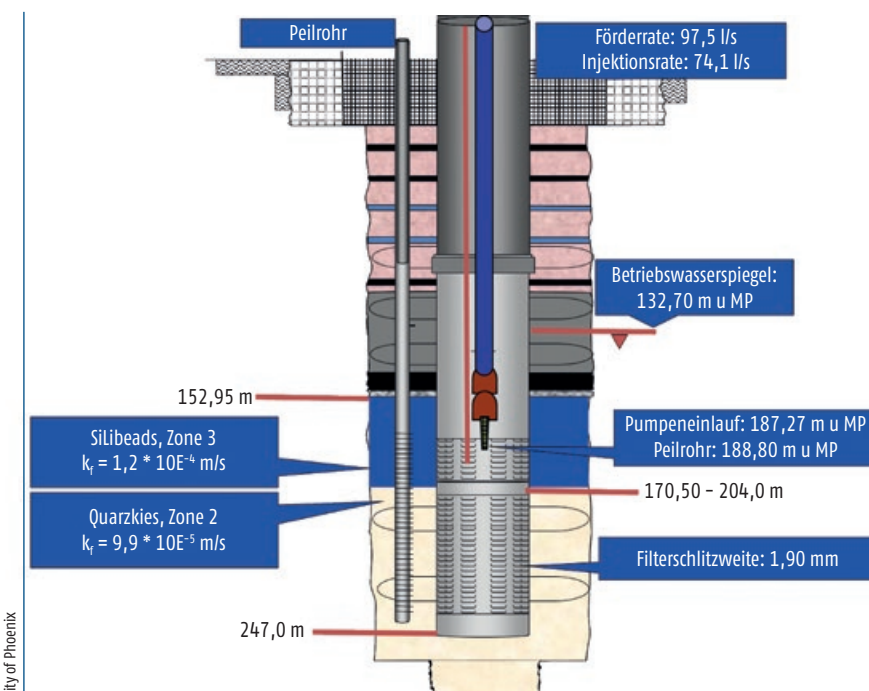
Ausbauplan des ASR-Brunnens in Cave Creek mit Darstellung der Untersuchungsbereiche
